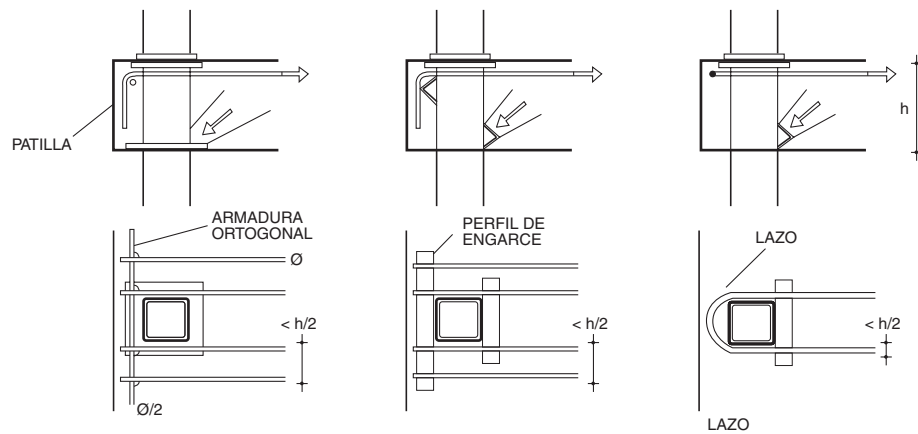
Armaduras superiores en nudo extremo con soporte metálico
